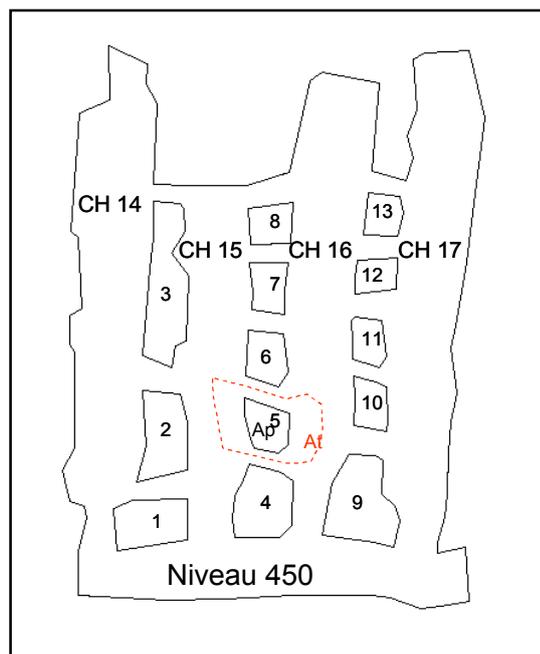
Plan digitalisé du quartier Extrême Nord. Ce plan est une projection sur le plan de la couche. En pointillé, aire tributaire  $A_t$  du pilier 5
